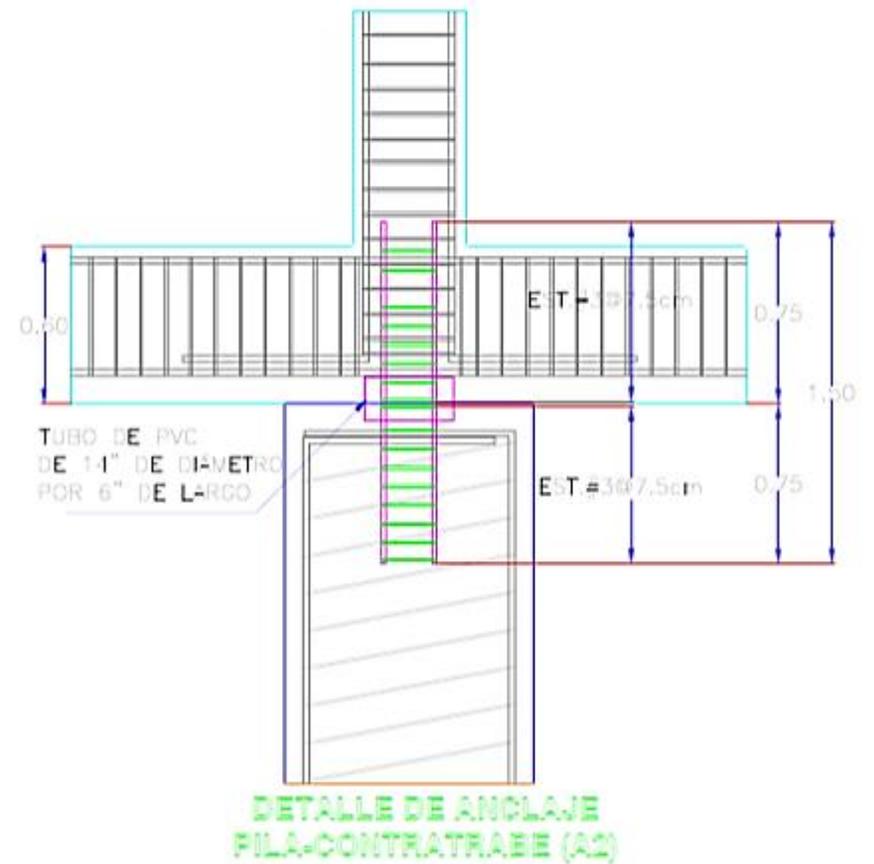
Detalle de proyecto de conexión de pilas y contratrabes.
